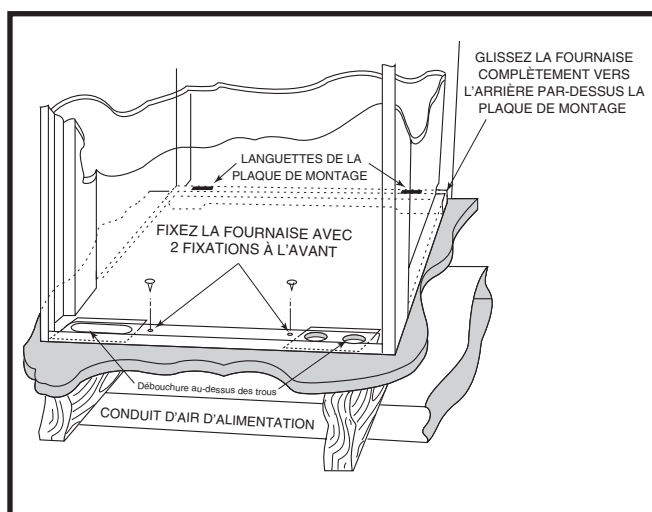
Fournaise de placard sur conduit d'air d'alimentation
